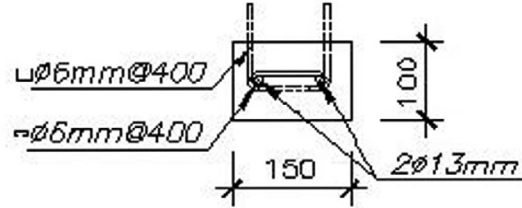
VISTA EN CORTE DEL REFUERZO DE LA PILASTRA ADOSADA.
